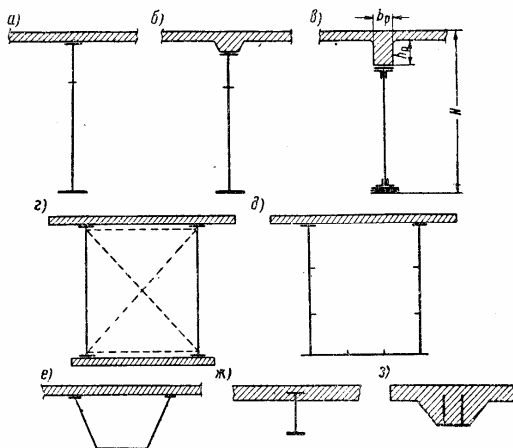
Схемы поперечных сечений сталежелезобетонных балок и пролетных строений: *a* – объединенное с плоской плитой; *б* – объединенное с низким ребром; *в* – объединенное с высоким ребром; *г* – двухплитное; *д* – коробчатое со стальной ортотропной плитой в нижнем поясе; *е* – трапециевидное коробчатое; *ж* – с втопленным верхним поясом; *з* – цельноперевозимая балка.
